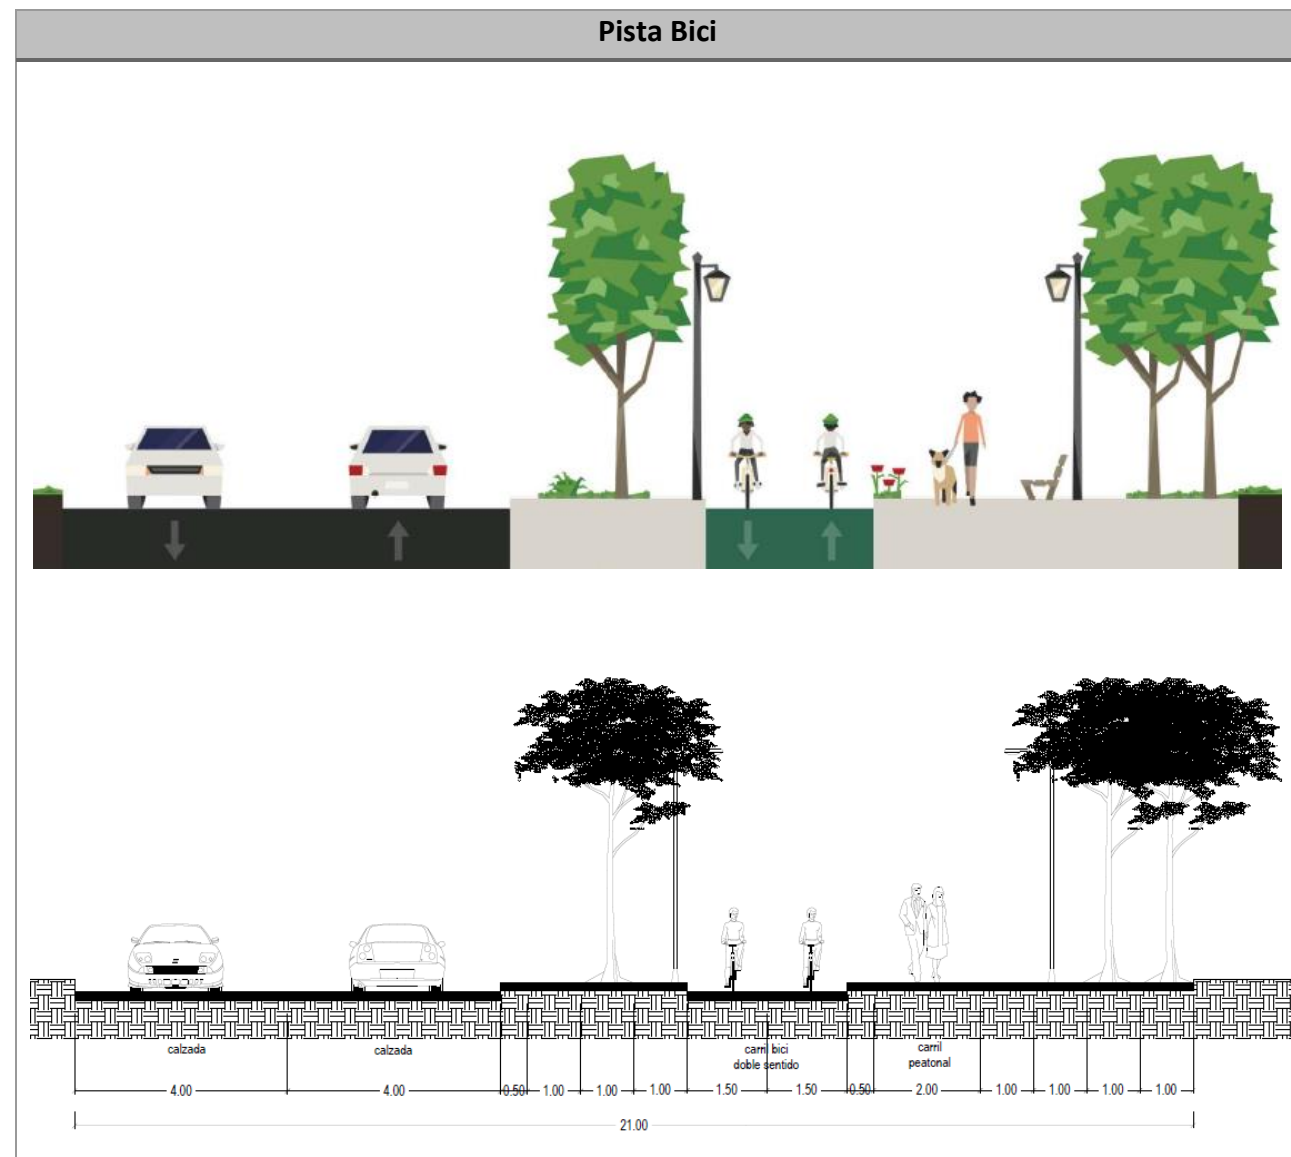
Sección transversal tipo para Pista Bici. Fuente: Elaboración propia.
